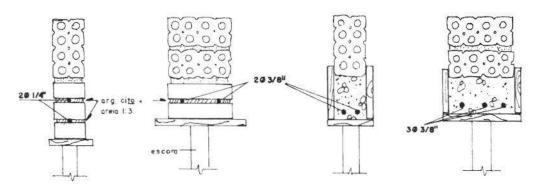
Vergas em alvenaria de tijolo furado para vãos até 1,00m e entre 1,00m e 2,00m.
